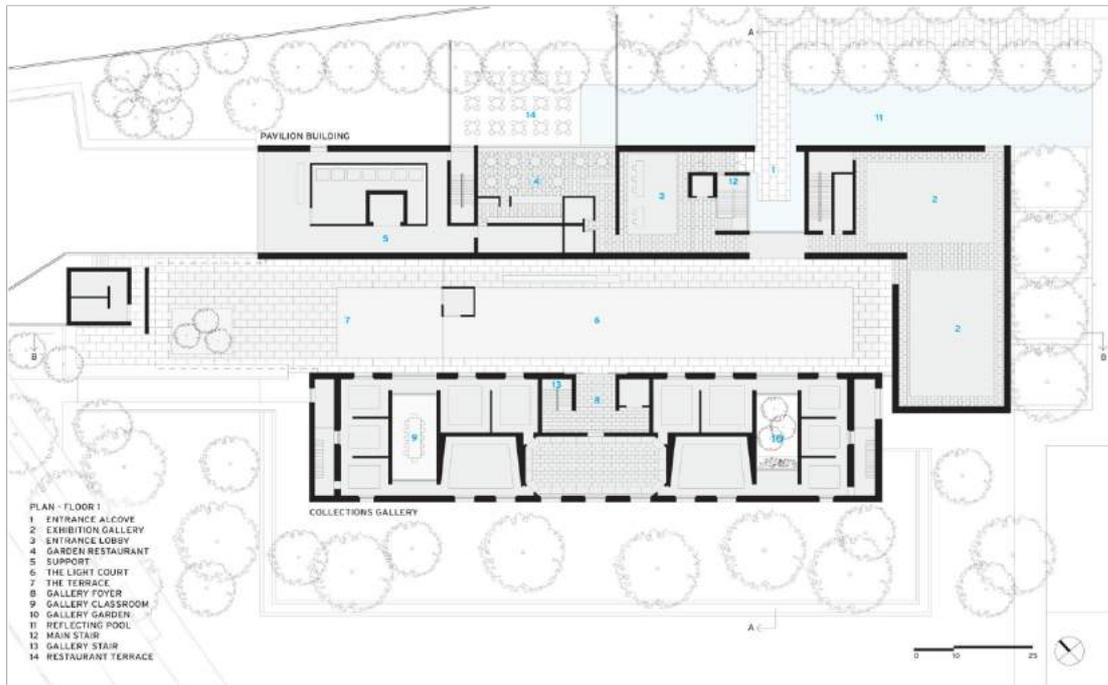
Planta Baixa Pavimento Térreo. Fonte: www.archdaily.com
